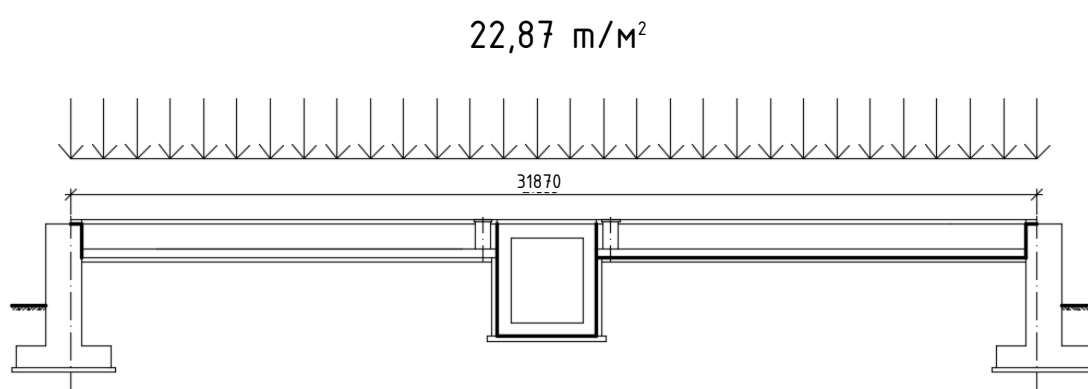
Розрахункова схема фундаменту силосу для зберігання зернових
